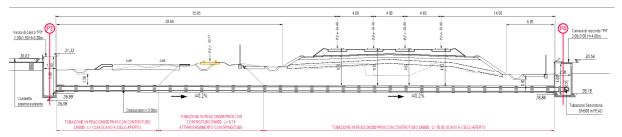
Attraversamento alla pk 27+125 – Sezione Longitudinale
